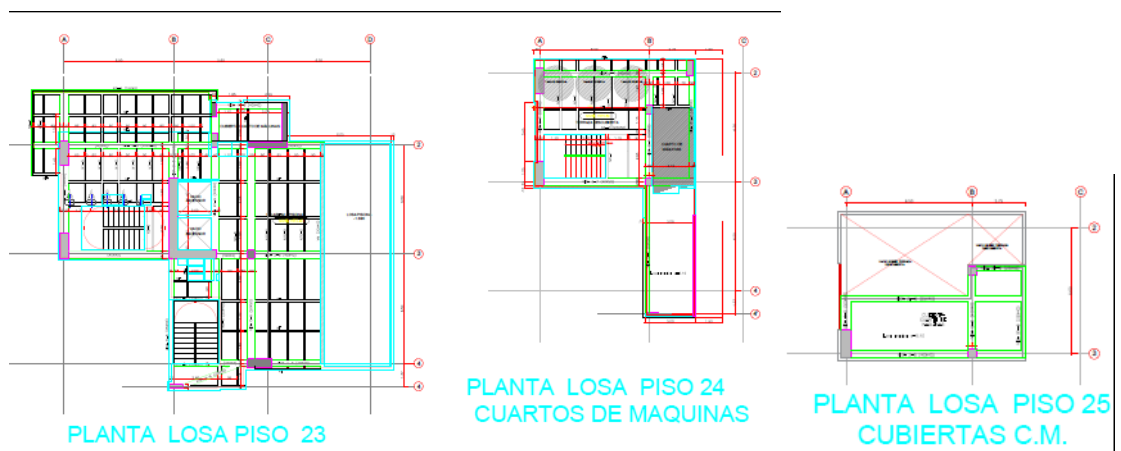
Vista en planta de piso 23, piso 24 y piso 25 (cubierta)
